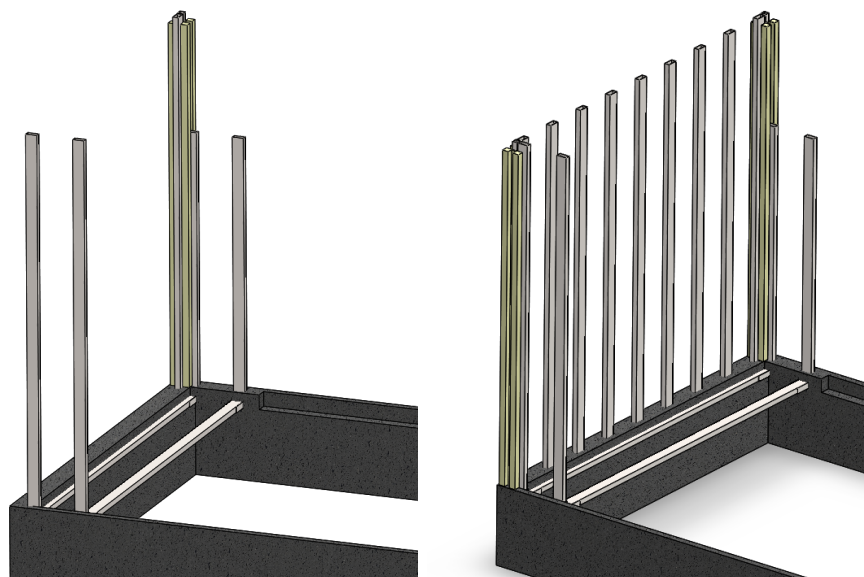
Base de betão com vigas do chão e pilares encastrados.
